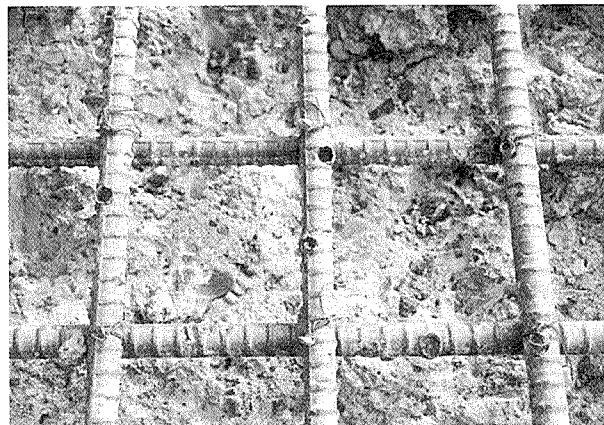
ブレーカによる鉄筋の損傷⁴⁾
